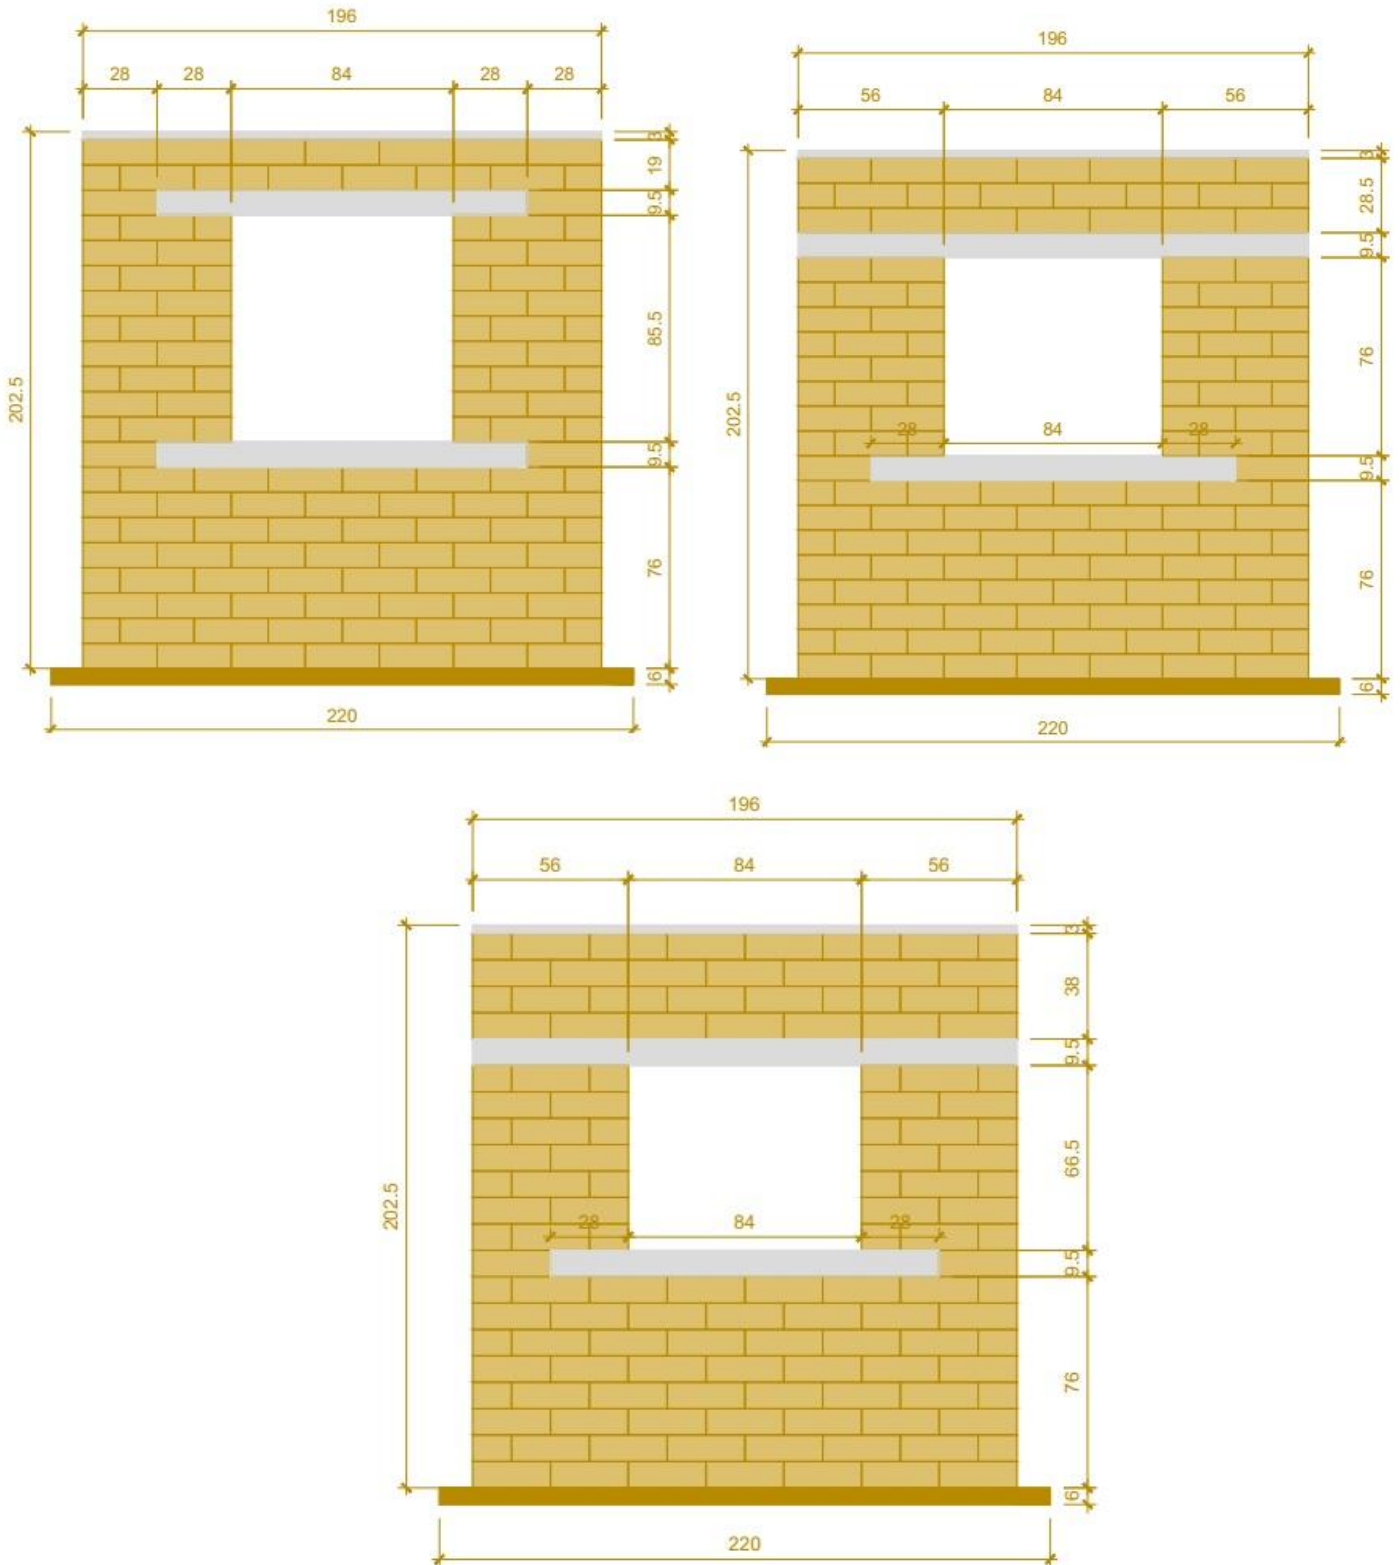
Esquemas para a construção das Paredes 1, 2 e 3, respectivamente.
